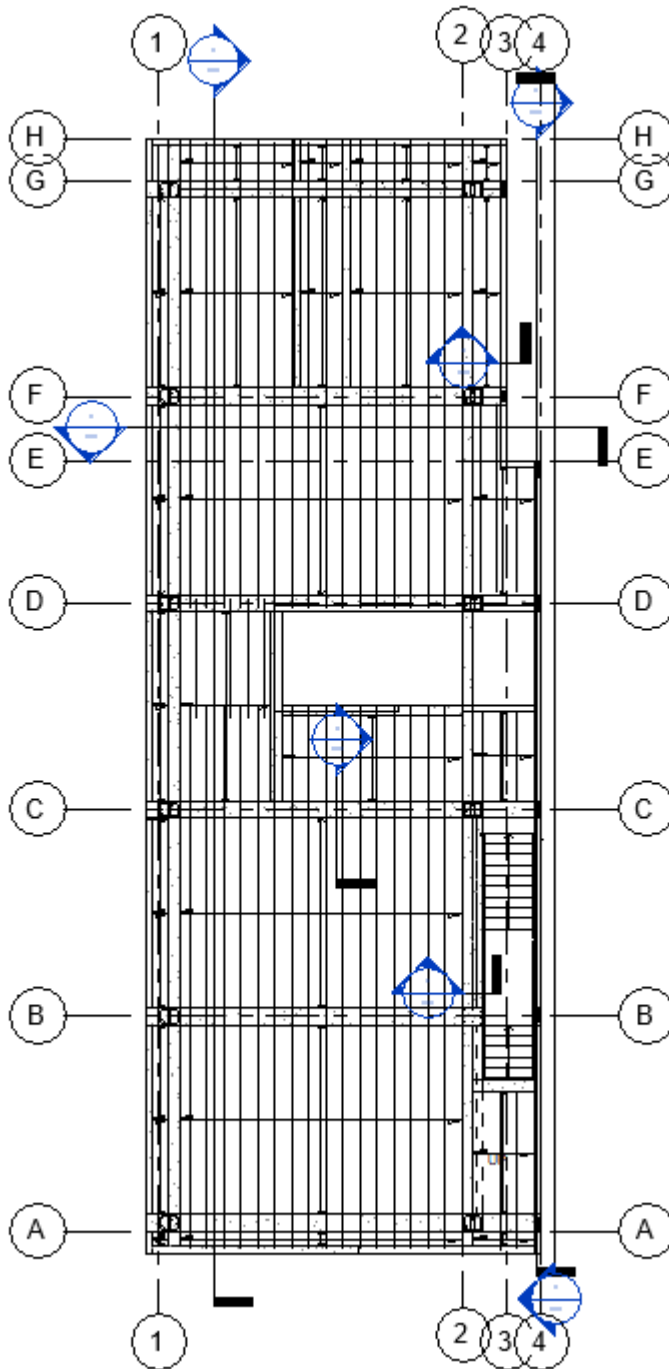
Vista Planta, distribución de acero en Losa Aligerada (Fuente: Elaboración Propia).
